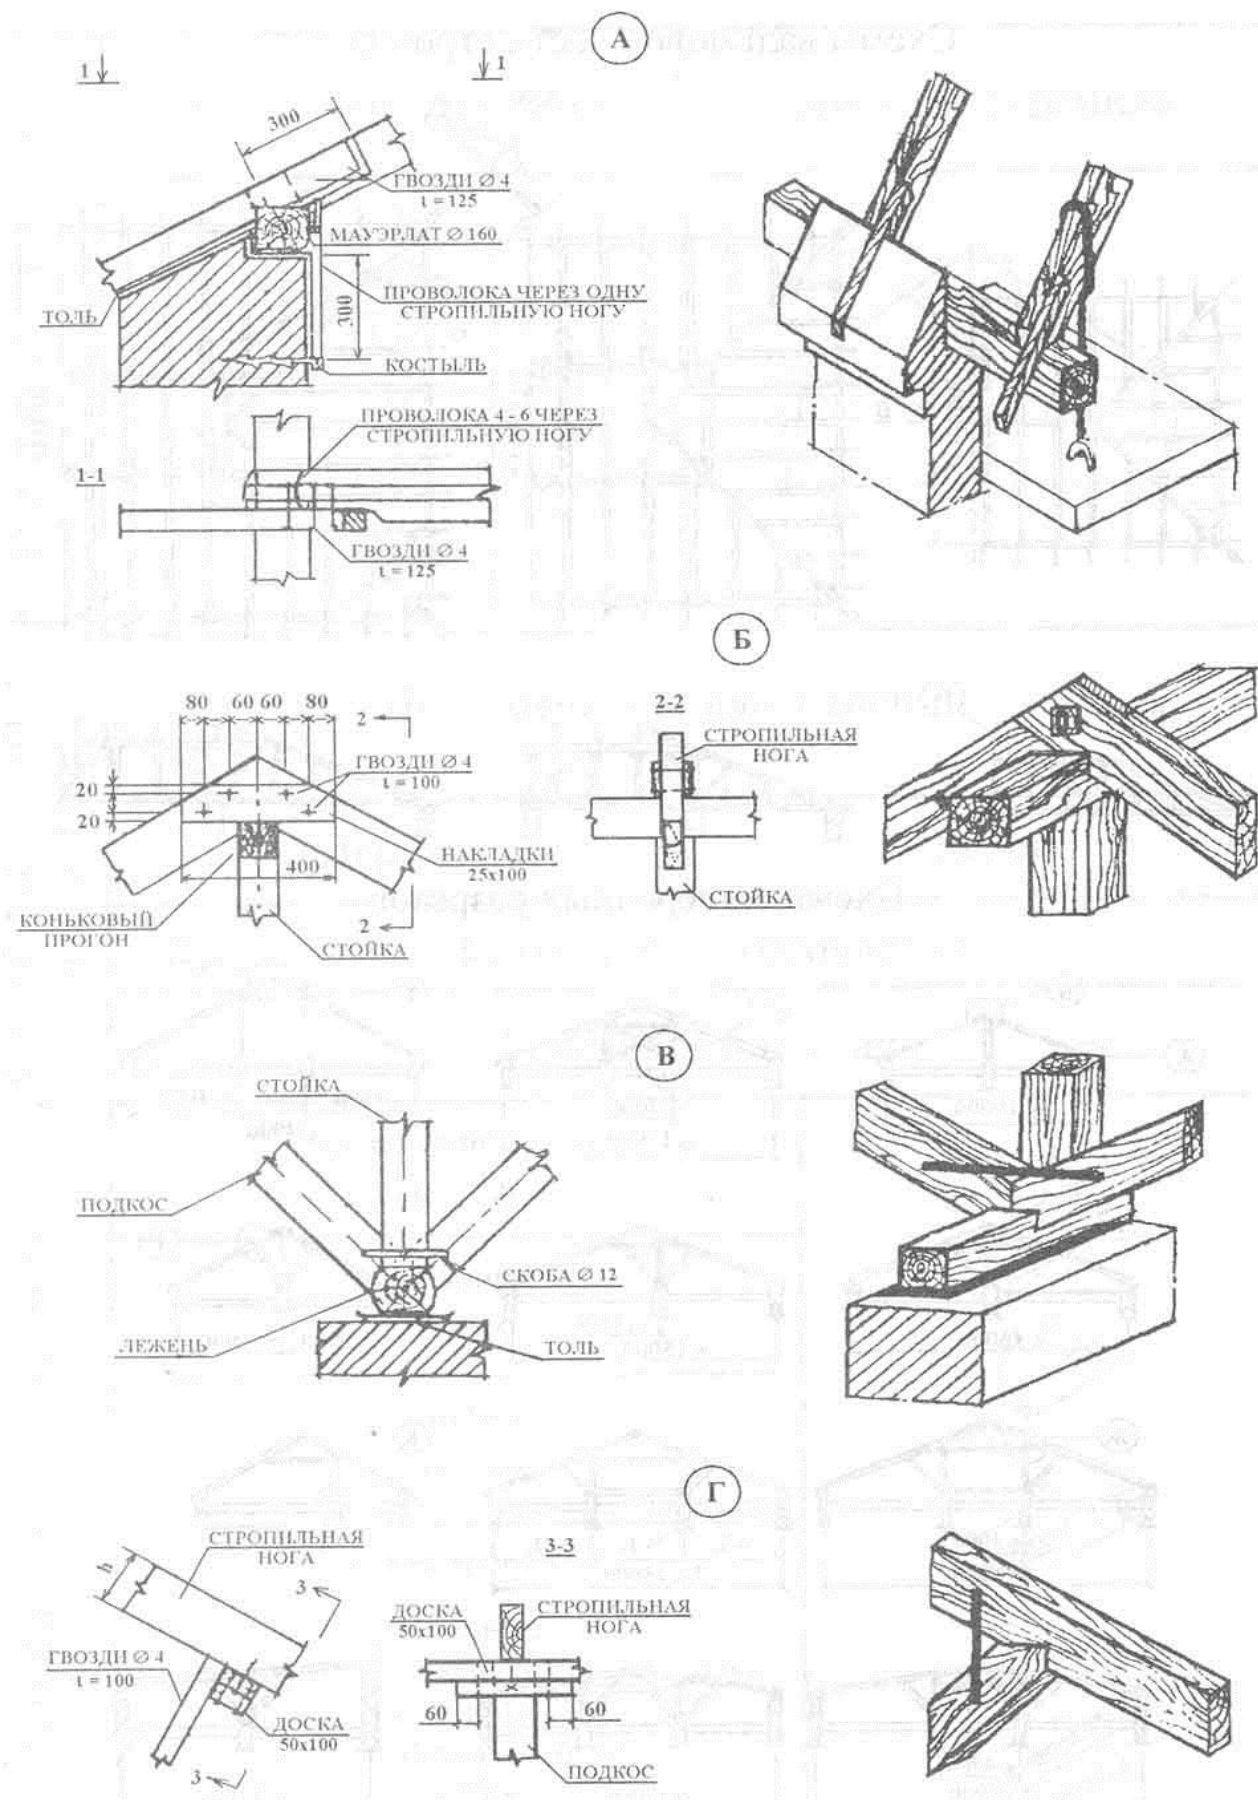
Узлы стропильных покрытий (узлы замаркированы на рисунке 3.18)
